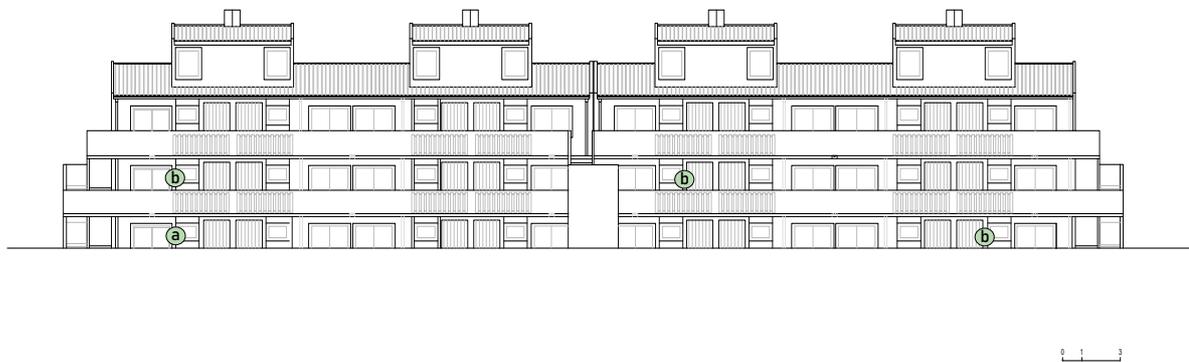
Alçado com as alterações na fachada do lote 2 na Parcela 6
